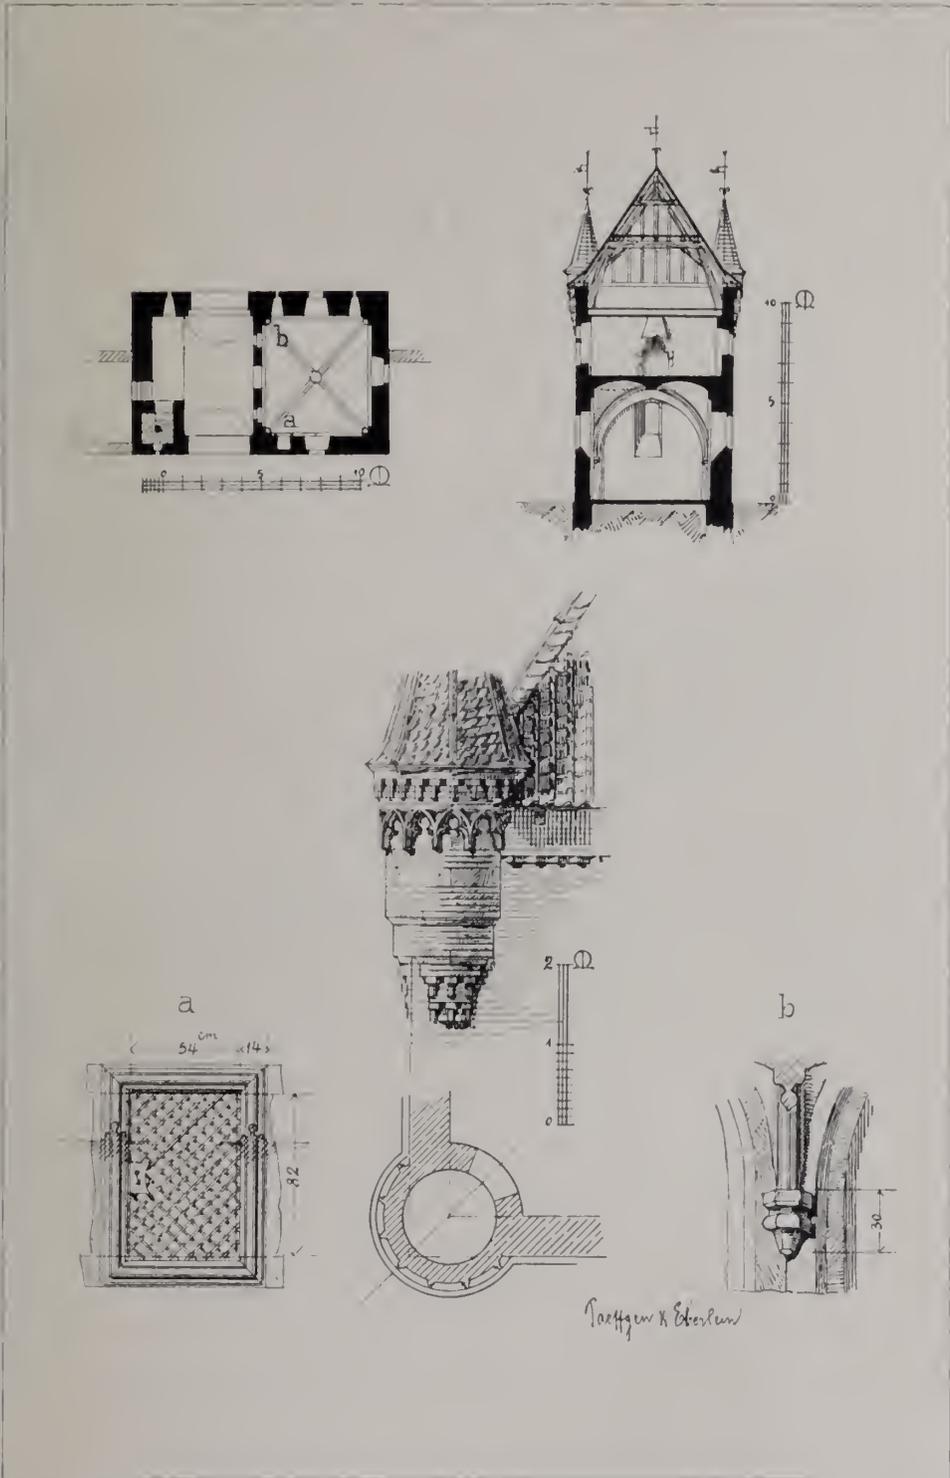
Burg Bocholt. Thorbau, Grundriss, Durchschnitt und Details.
